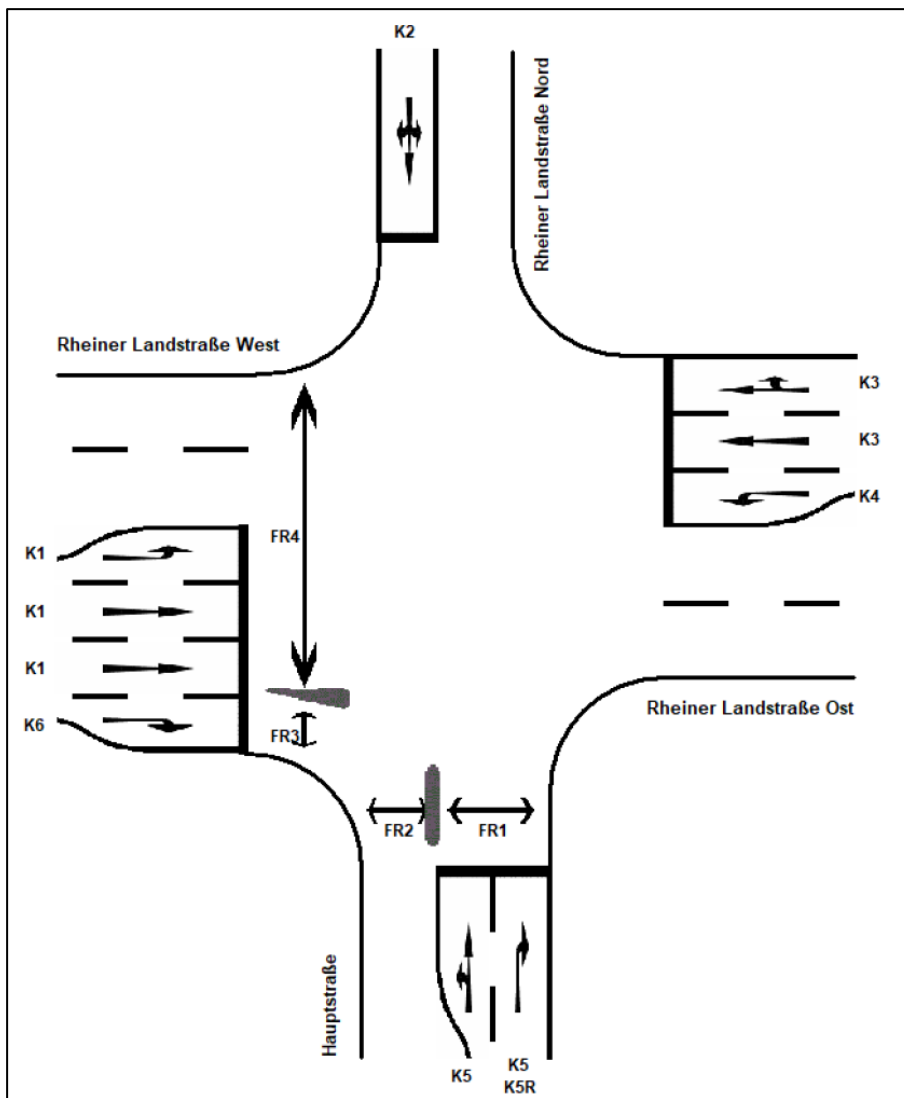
Signallageplan LSA Rheiner Landstraße / Hauptstraße
